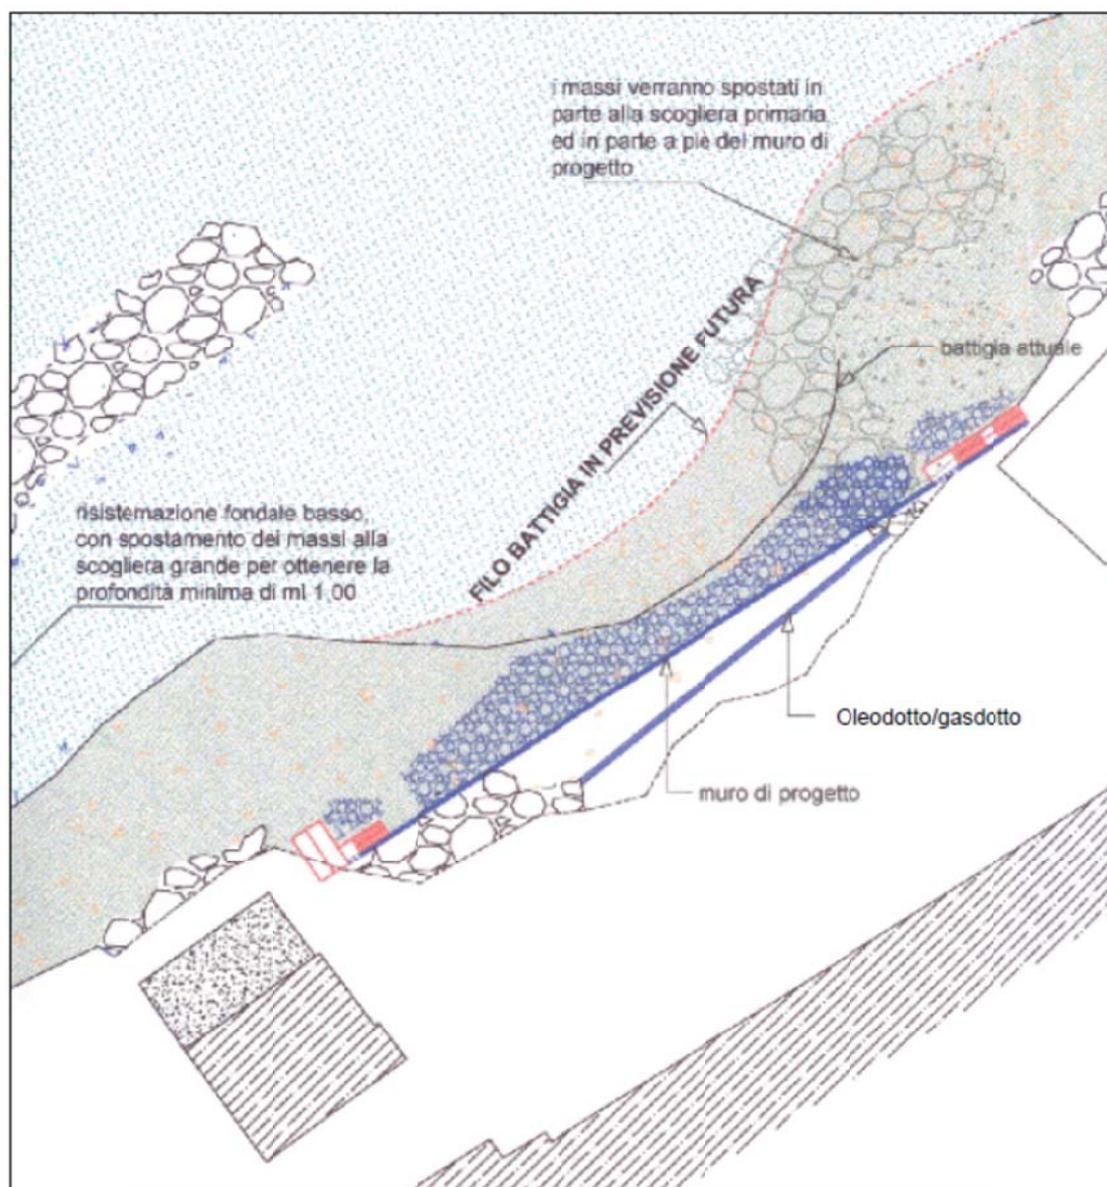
Stralcio della previsione di progetto- I° intervento -2001
